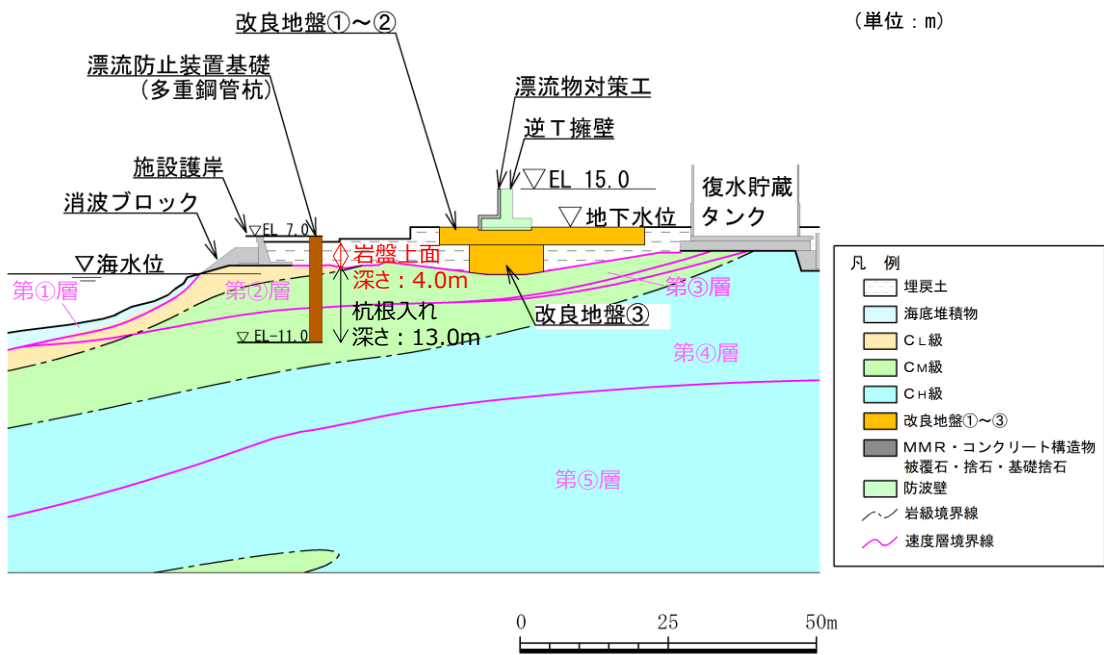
漂流防止装置基礎（多重鋼管杭）の横断面図（②-②断面）
